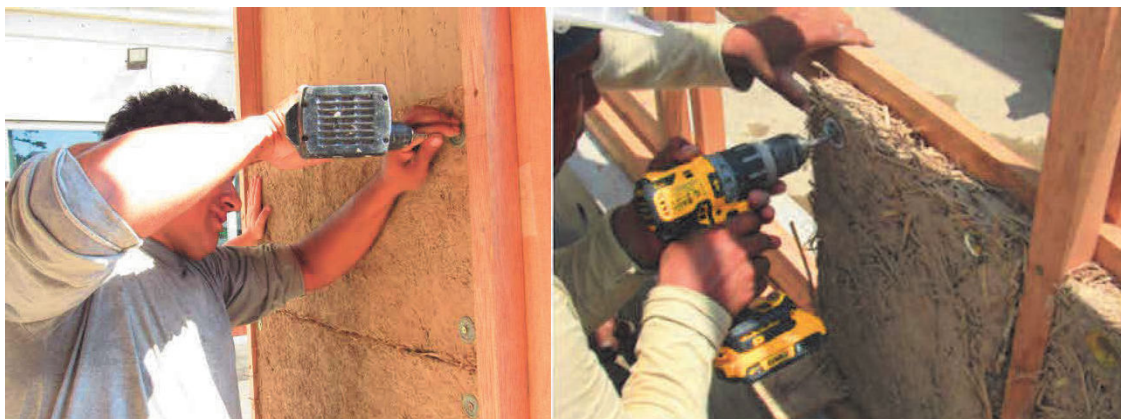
Atornillado de elementos en tierra alivianada en panel de quincha (crédito: Archivo Proyecto Quincha, 2018). Atornillado de elementos en TA en el sistema propuesto (crédito: Archivo de proyecto, 2019).
